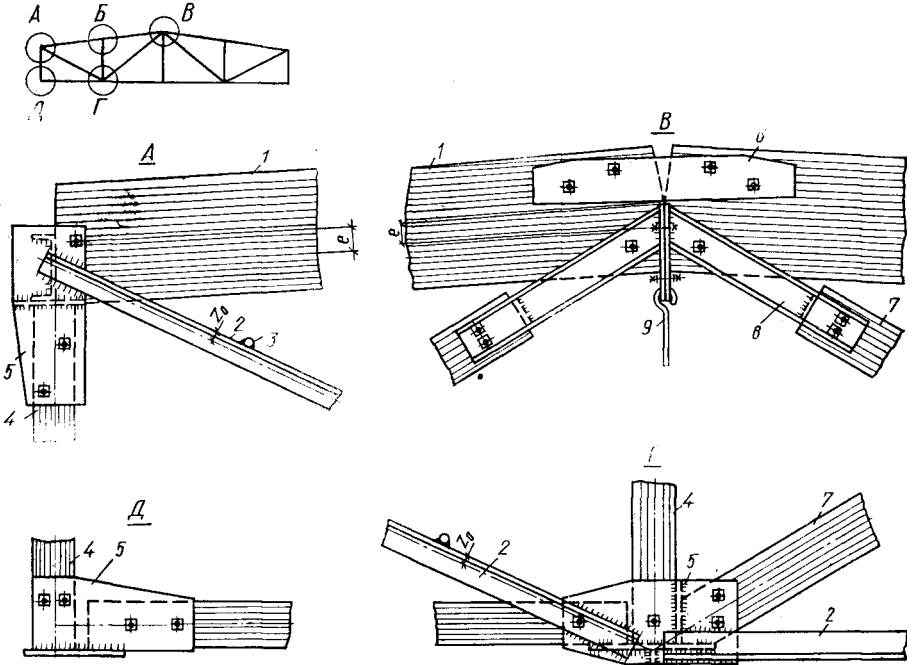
Металлодеревянная ферма с верхним клееным поясом:
